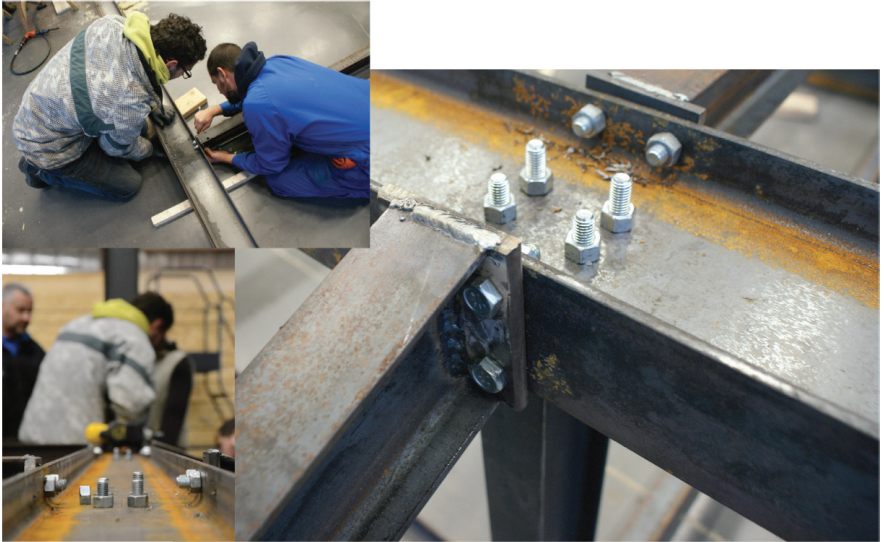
Verbindung der Stahlelemente mit Schrauben (2011)
